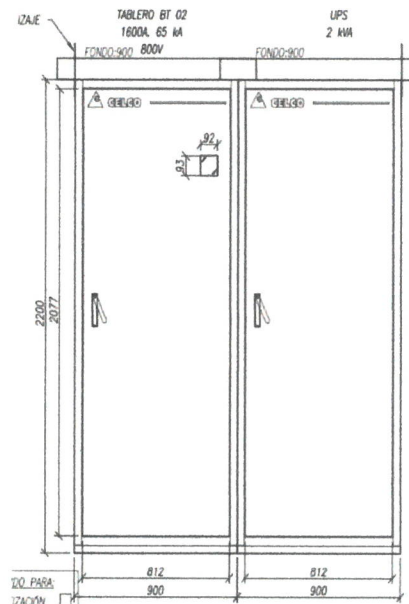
Esquema típico de fachadas para un tablero de baja tensión
